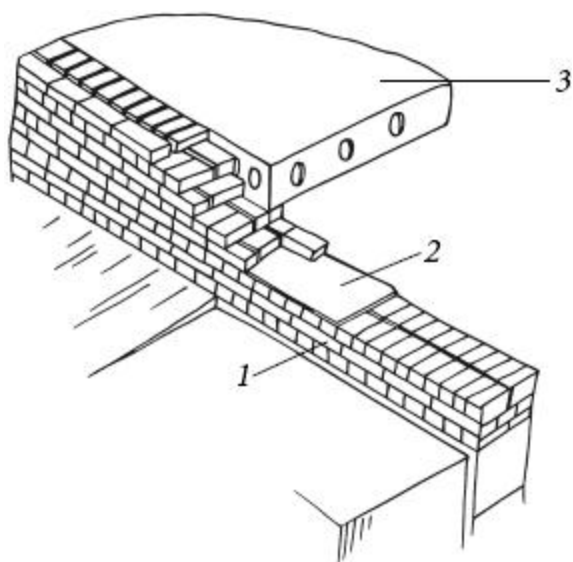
Устройство цементной горизонтальной гидроизоляции стен: 1) цокольная часть стены ниже «гидроизоляционной» отметки; 2) слой цементного раствора с добавками (гидроизоляция); 3) перекрытие первого этажа
